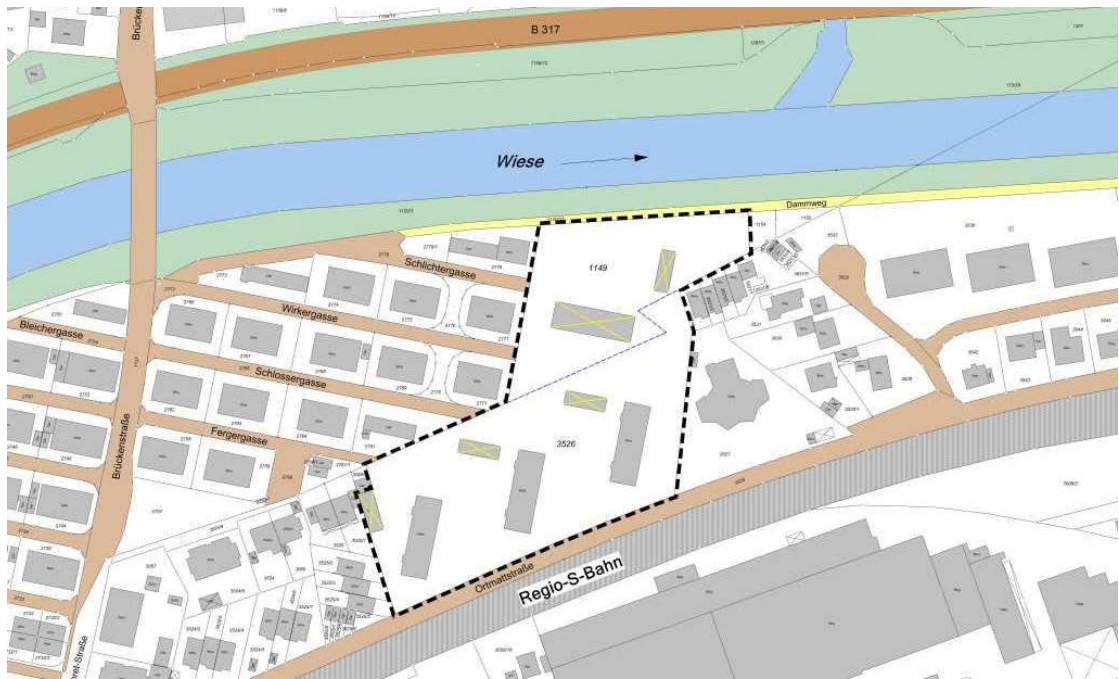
Abgrenzung des Plangebiets. Das Wohngebäude auf Flurstück-Nr. 1149 wird abgebrochen, die Garagengebäude stehen zur Disposition. Plan: Stadtbau Lörrach
